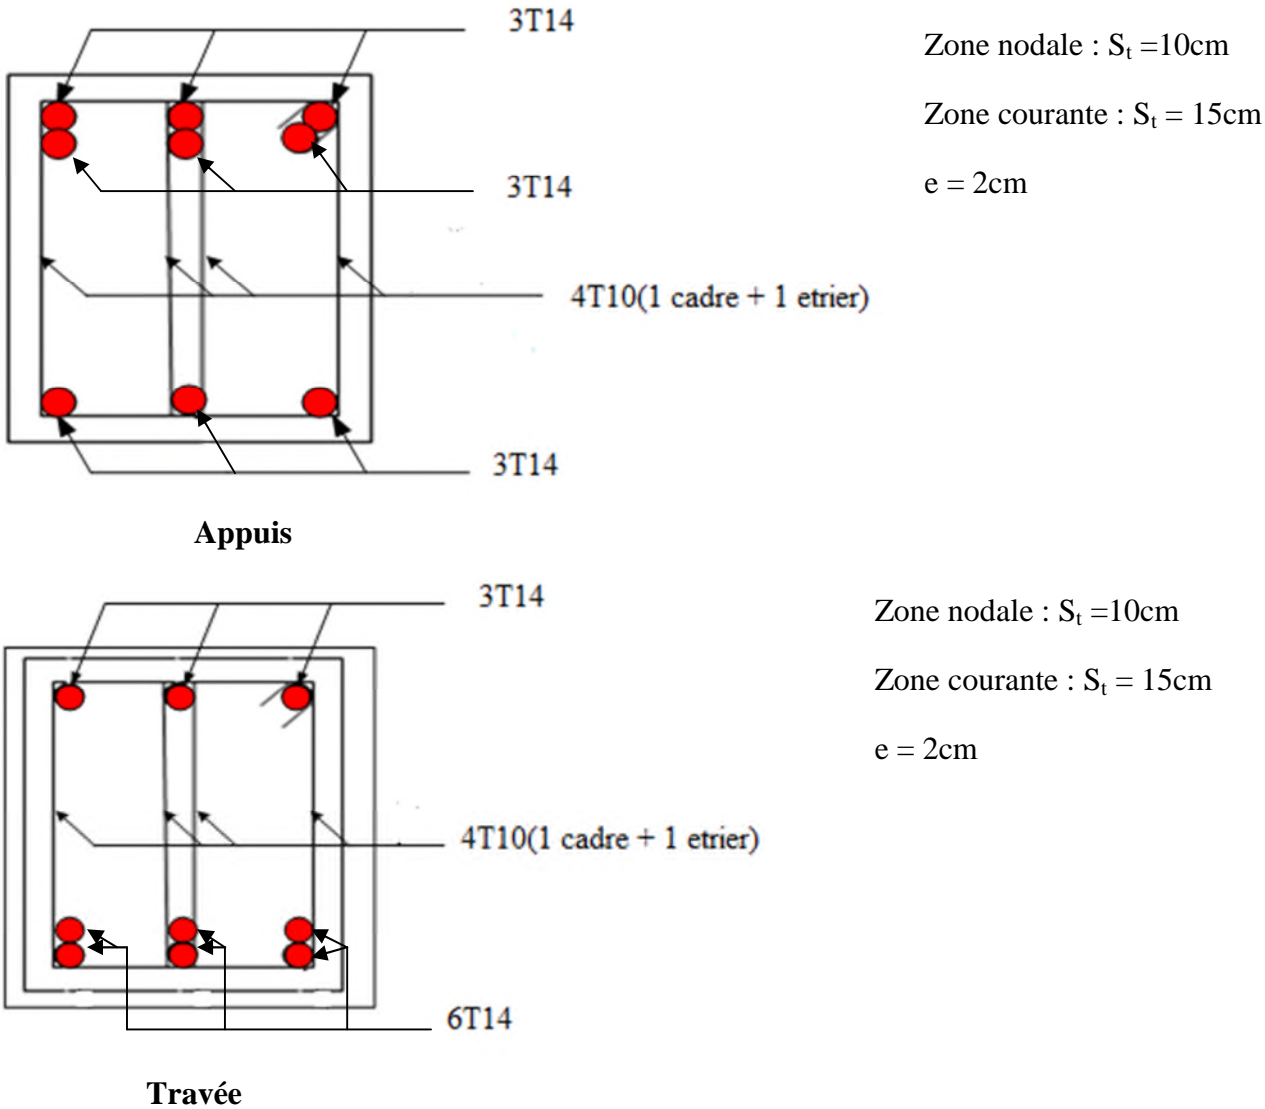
Schéma de ferrailage des poutres principales du 5^{ème} et 6^{ème} étage.
